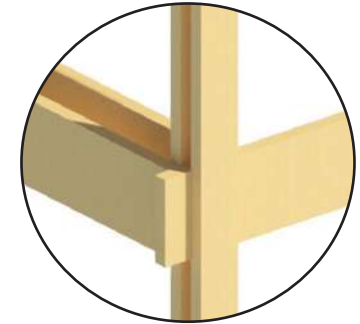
Detalle columnas y vigas en madera laminada. Fuente: Elaboración propia. (2017)
